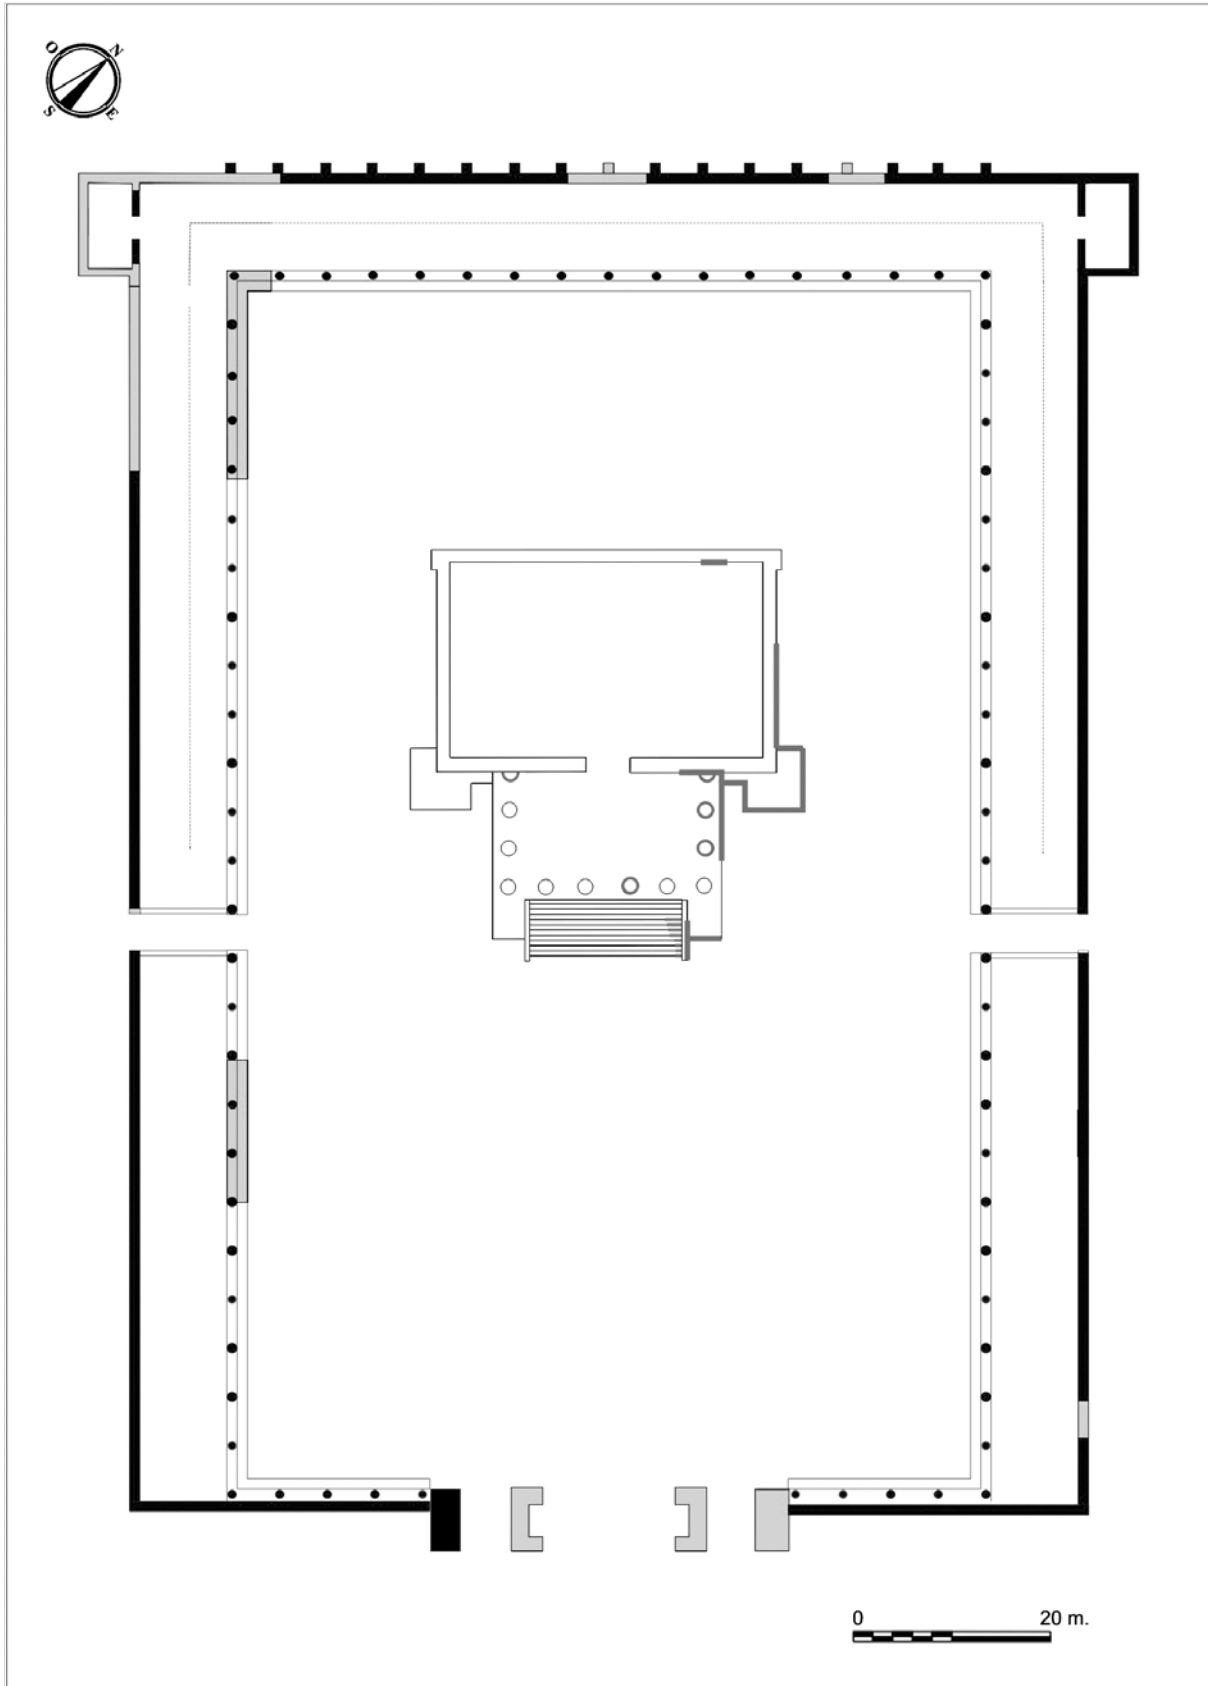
Reconstrucción de la planta del Conjunto Provincial de Culto Imperial.
